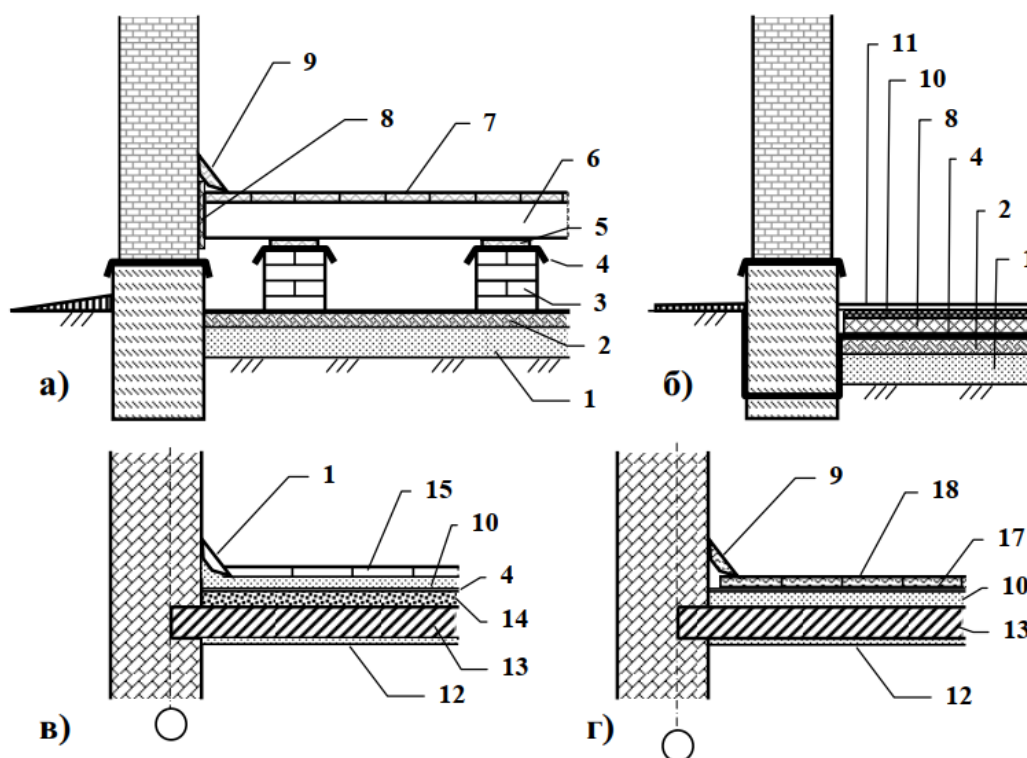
Приклади влаштування підлог: а – дощата підлога на ґрунті (на цегляних стовпчиках); б – підлога на ґрунті; в – підлога з метласької плитки на перекритті; г) паркетна підлога на перекритті; 1 – підсіпка піщана; 2 – бетонне підготовлення; 3 – цегляний стовпчик; 4 – гідроізоляція; 5 – антисептована прокладка; 6 – лага; 7 – дощата підлога; 8 – теплоізоляція; 9 – плінтус; 10 – цементна стяжка; 11 – підлога; 12 – штукатурка; 13 – плита перекриття; 14 – шлакобетонна стяжка; 15 – метласька плитка; 16 – керамічний плінтус; 17 – клеюча мастика; 18 – паркет
